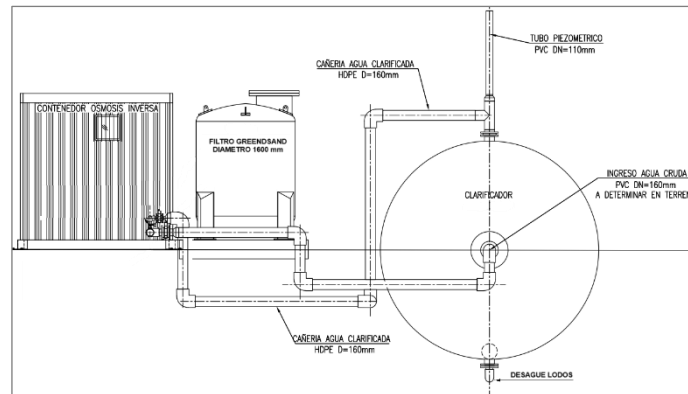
Diagrama pretratamiento planta potabilizadora- sección
